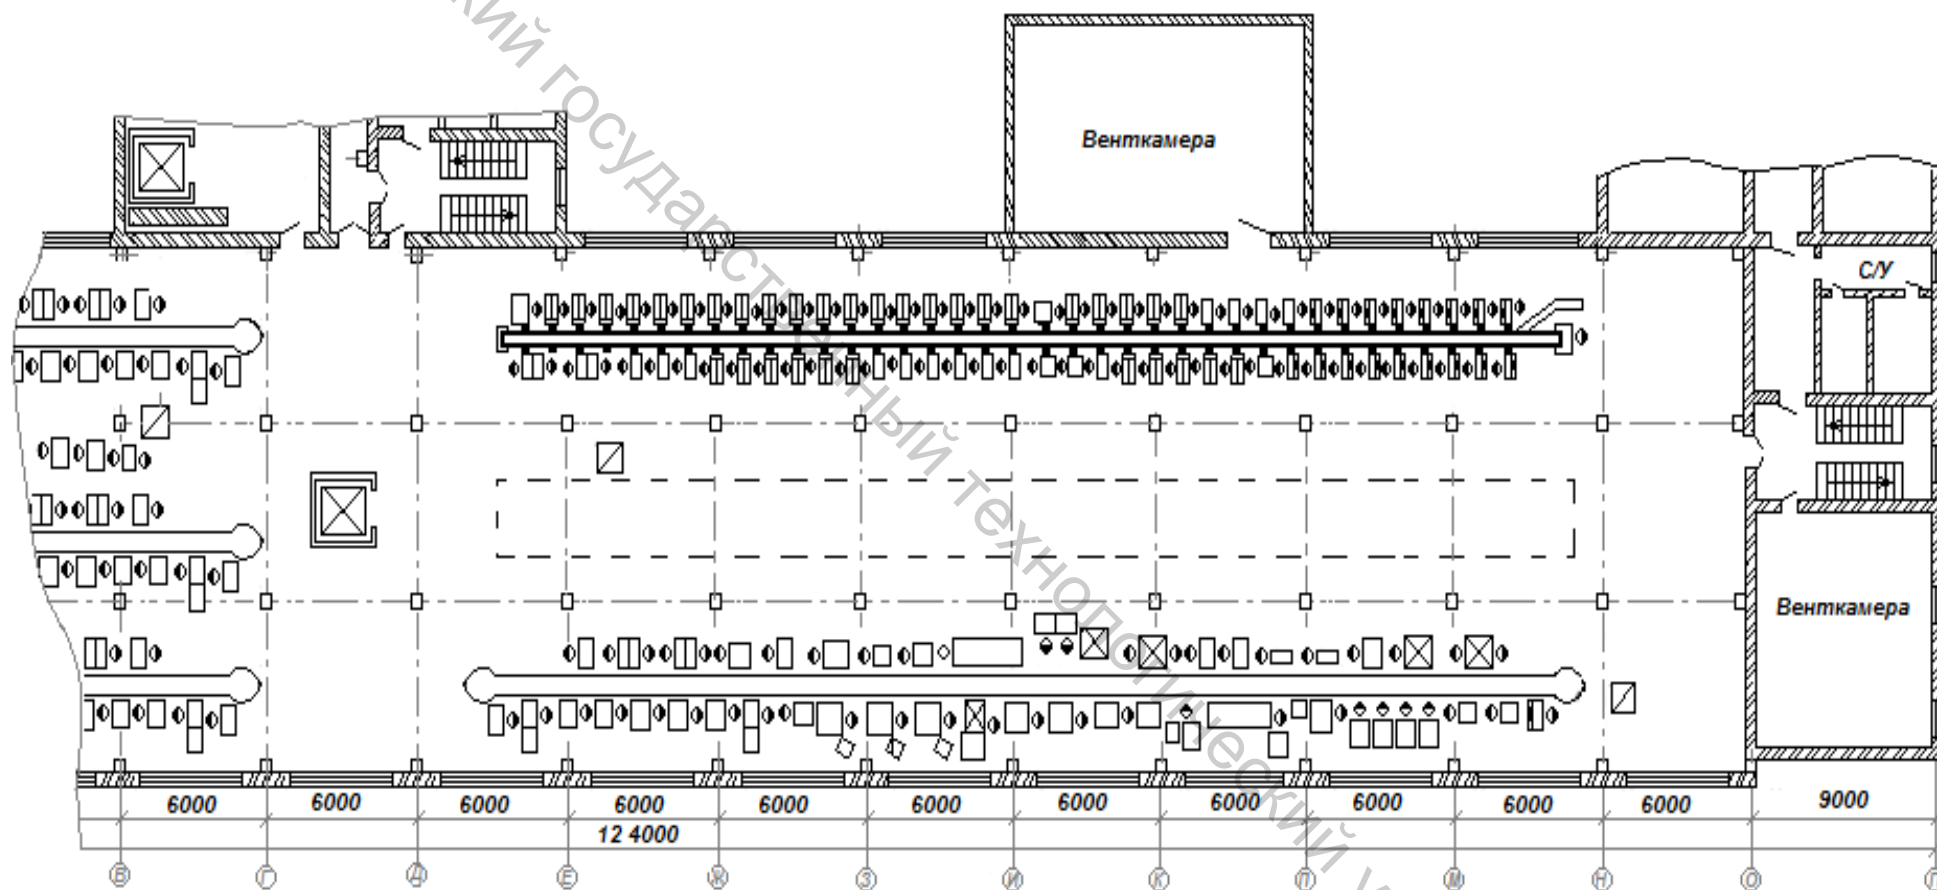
Вариант компоновки позального размещения потоков сборки заготовок верха и обуви
